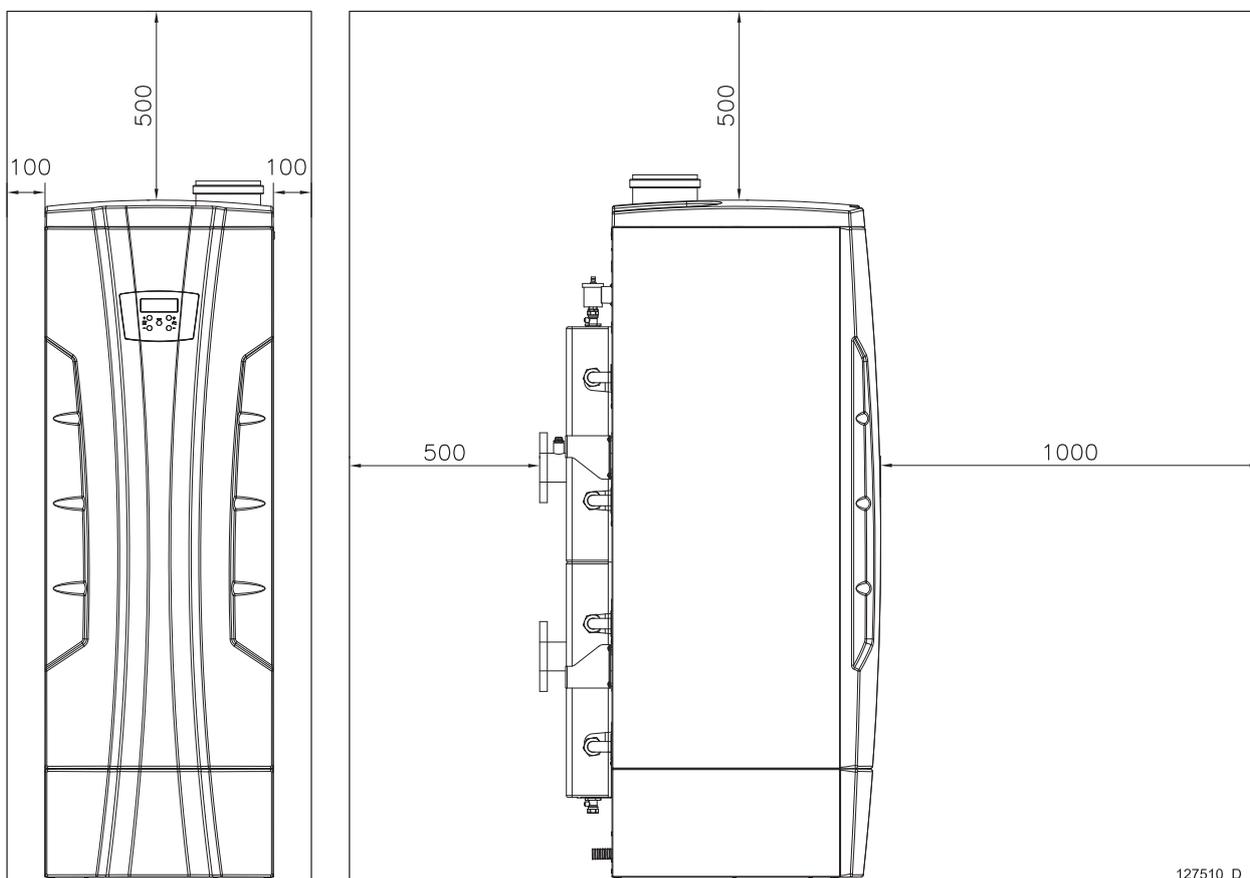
Distanze minime di rispetto modelli 180T-210T-280T
